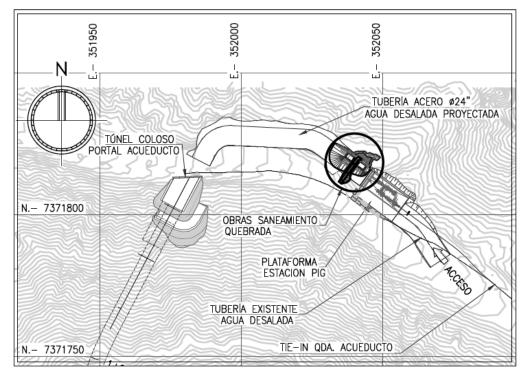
Disposición obra de saneamiento estación lanzadora.
